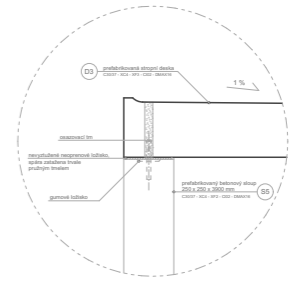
DETAIL NAPOJENÍ PREFA. STROPNÍCH DESEK KOLONÁDY
